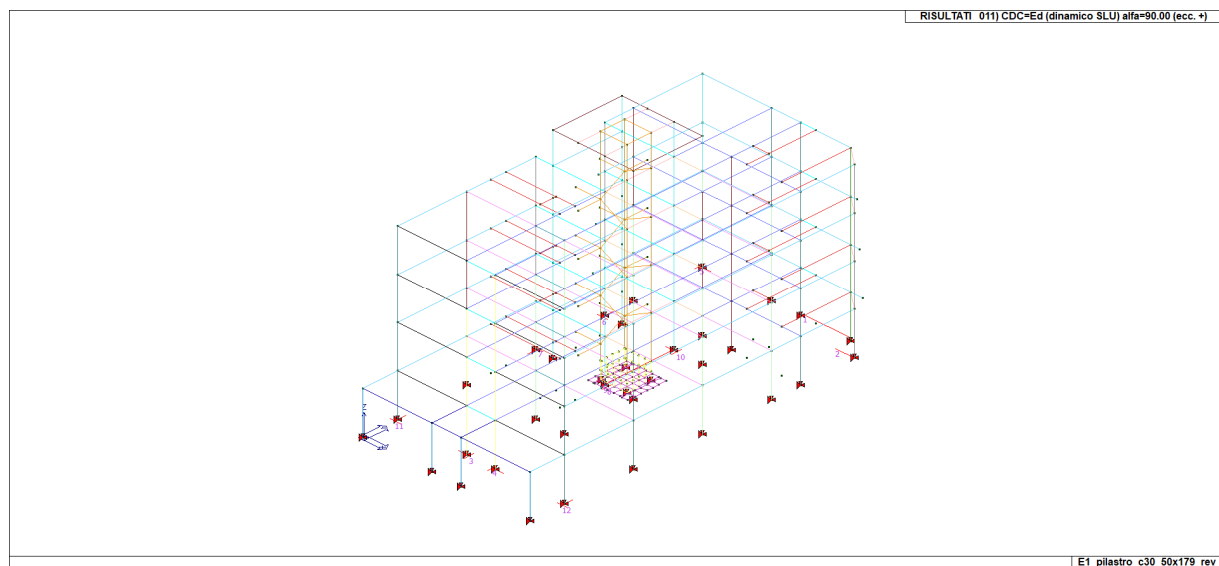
Vista assonometrica modello struttura in elevazione – solo travi/pilastri
